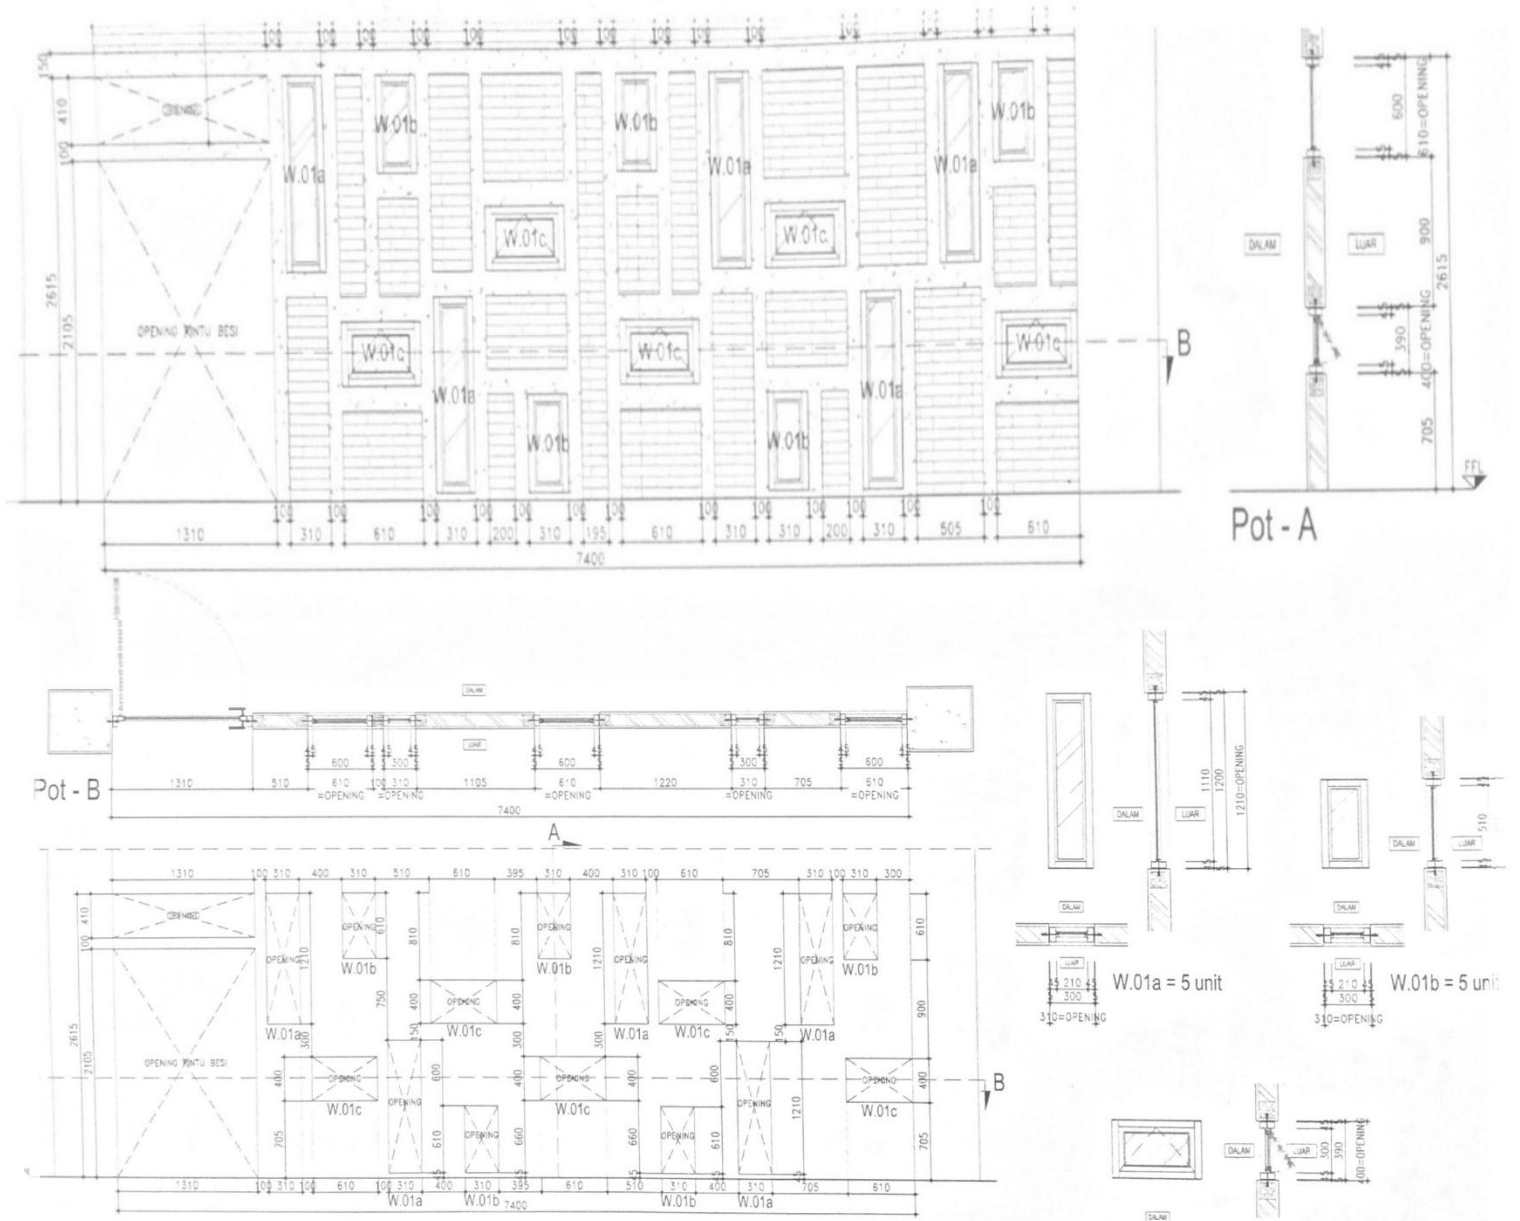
Denah Kunci Rencana Kusen lantai 1
